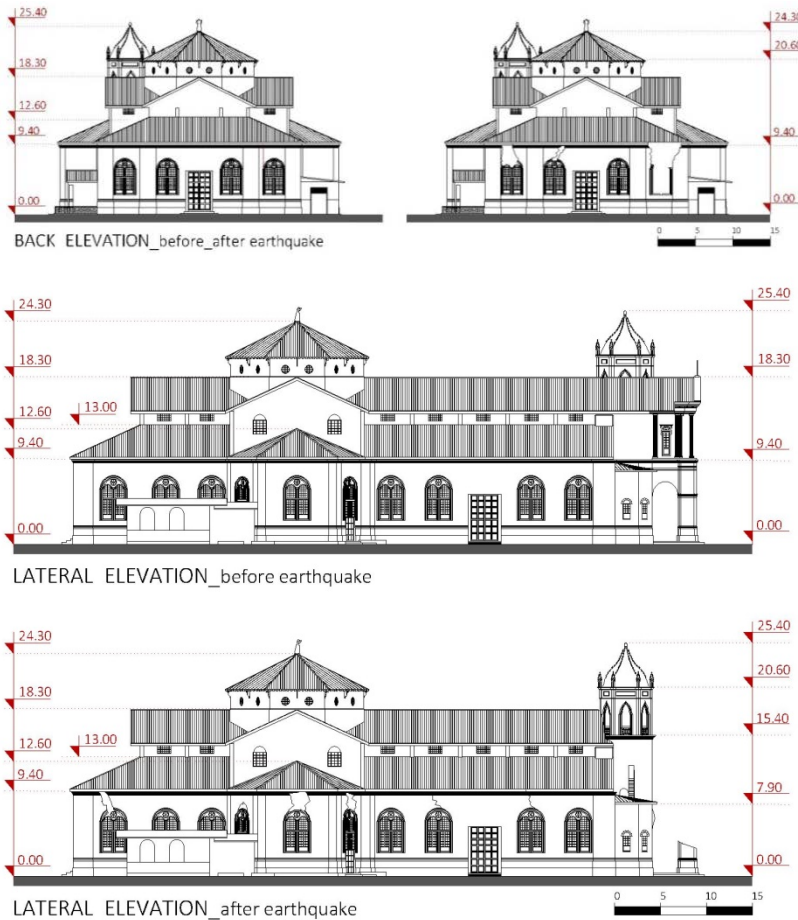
e: Daus: Prospetto lato mare e Prospetto laterale prima e dopo il terremoto
